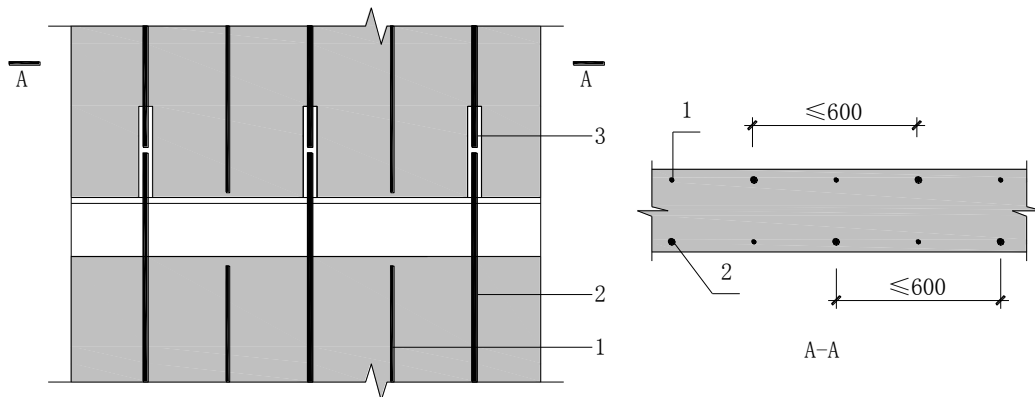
竖向分布钢筋套筒灌浆连接“梅花形”部分连接构造示意
